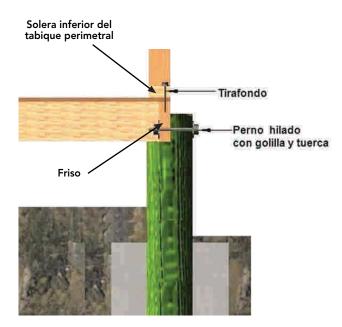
23: Corte intermedio de viga perimetral del entramado horizontal, se fija a cada pilote mediante perno hilado con golillas y tuerca, cuyas dimensiones las determina el cálculo. Normalmente son de un diámetro mínimo de 12 mm y largo de 7" a 8" (170 a 200 mm). Solera inferior del tabique perimetral se fija al friso mediante tirafondos cada 0,40 m, definidos según cálculo.
